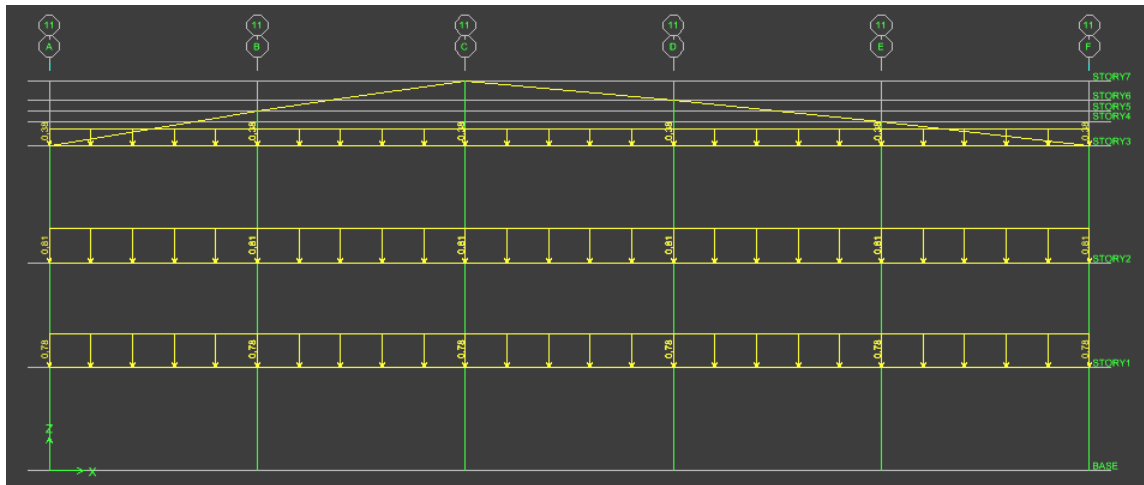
Asignación de carga muerta sobre vigas perimetrales.
